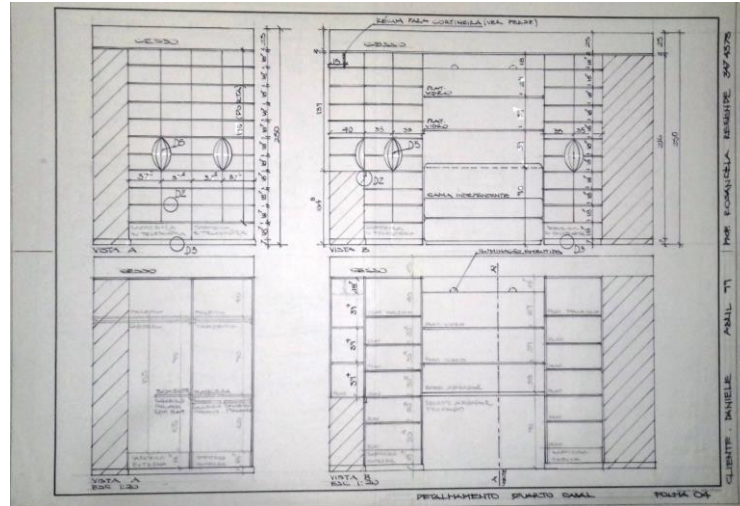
Detalhamento dos armários, Sra. Daniele.
